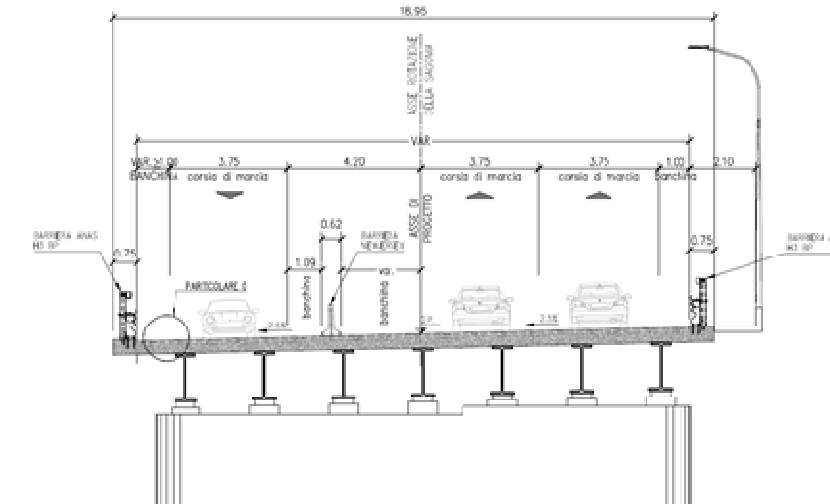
Asse principale – Sezione tipo viadotto rampa bidirezionale 1+2 corsie svincolo Collestrada
